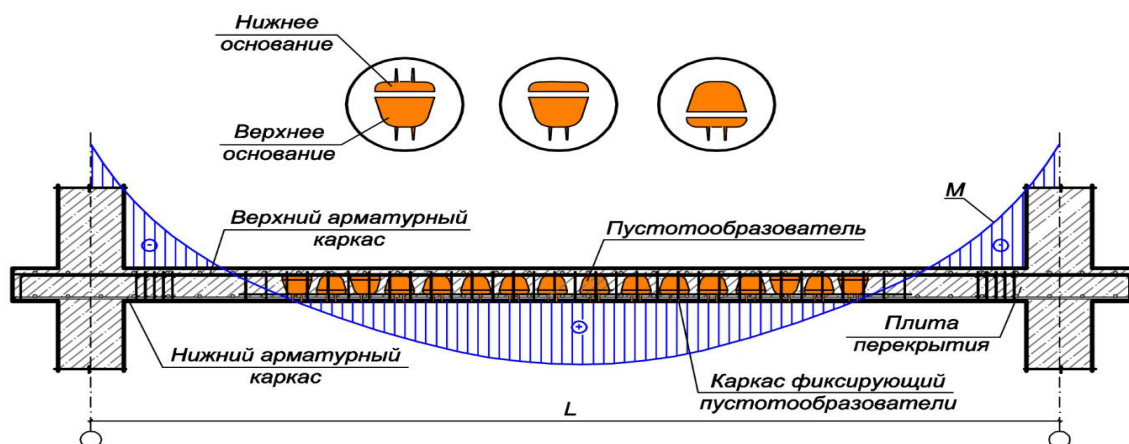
Предложенная конструкция чередования пустотообразователей в соответствии с расчетными усилиями в плите перекрытия
